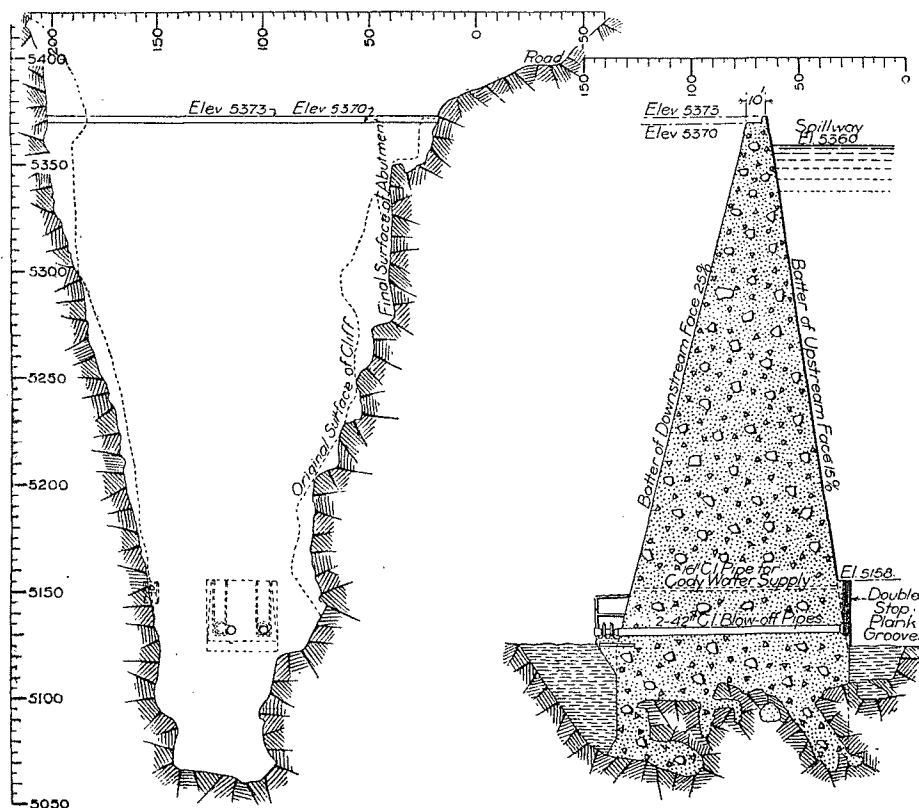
Coupe de la gorge à l'emplacement du barrage
